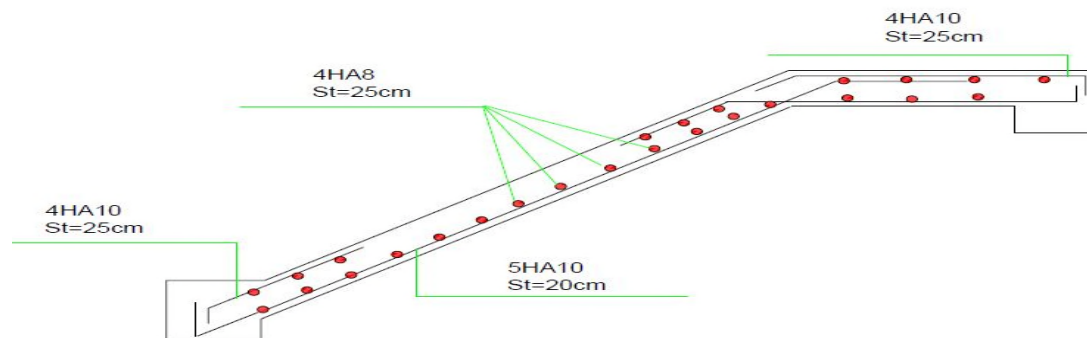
Schéma de ferrailage de l'escalier type 2, volée 1 et 3
